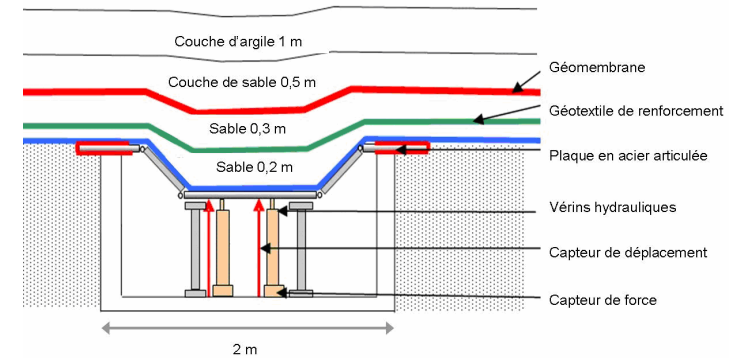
Présentation de l'essai de tassement sur site d'après Camp (2008).
